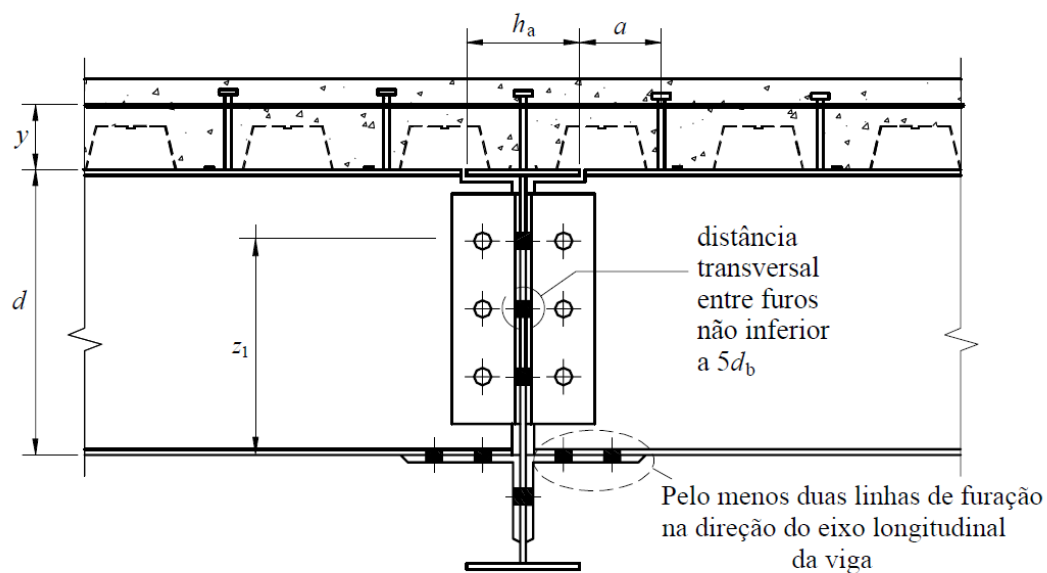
Ligação mista com cantoneiras parafusadas na alma (duas por viga) e na mesa inferior da viga apoiada [NBR 8800:2008]
